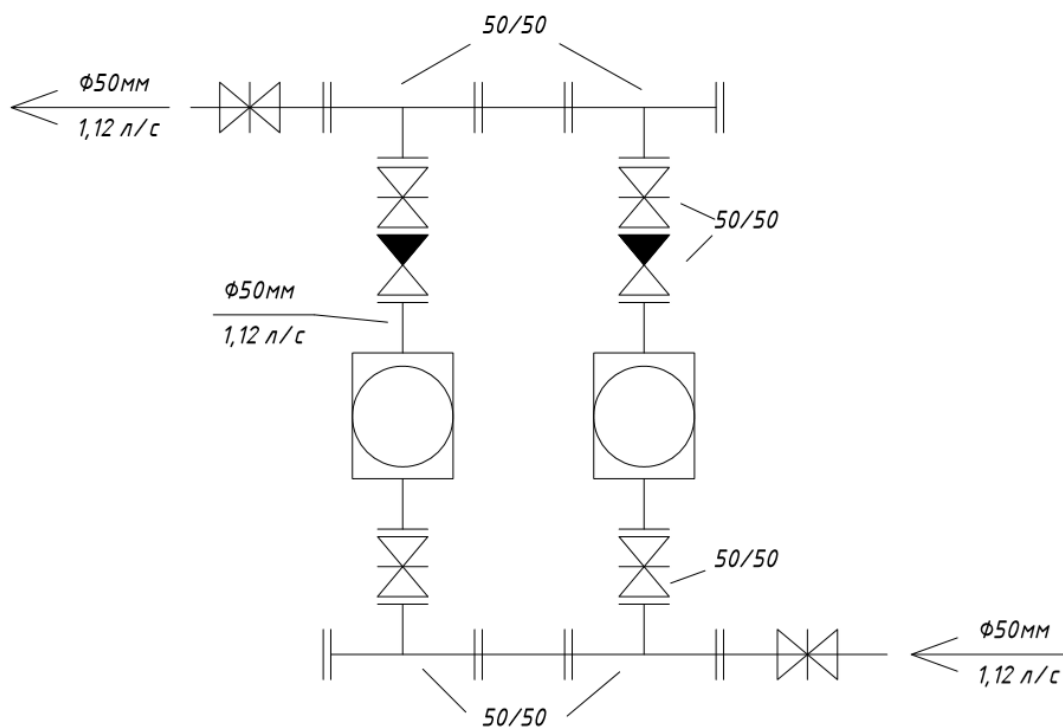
Схема расположения насосных агрегатов, трубопроводов, арматуры и фасонных частей в насосной станции второго подъема
